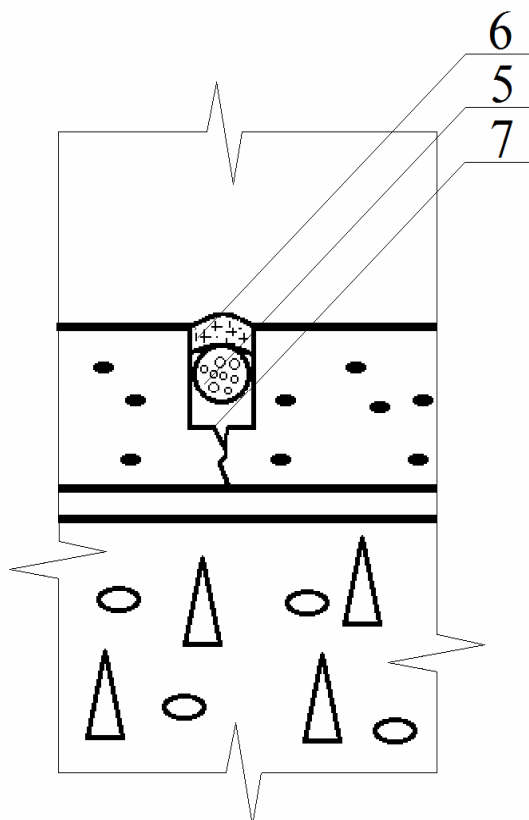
Узлы примыкания полимерных промышленных полов к стенам и колоннам и оформление усадочных (деформационных) швов шириной до 10мм
